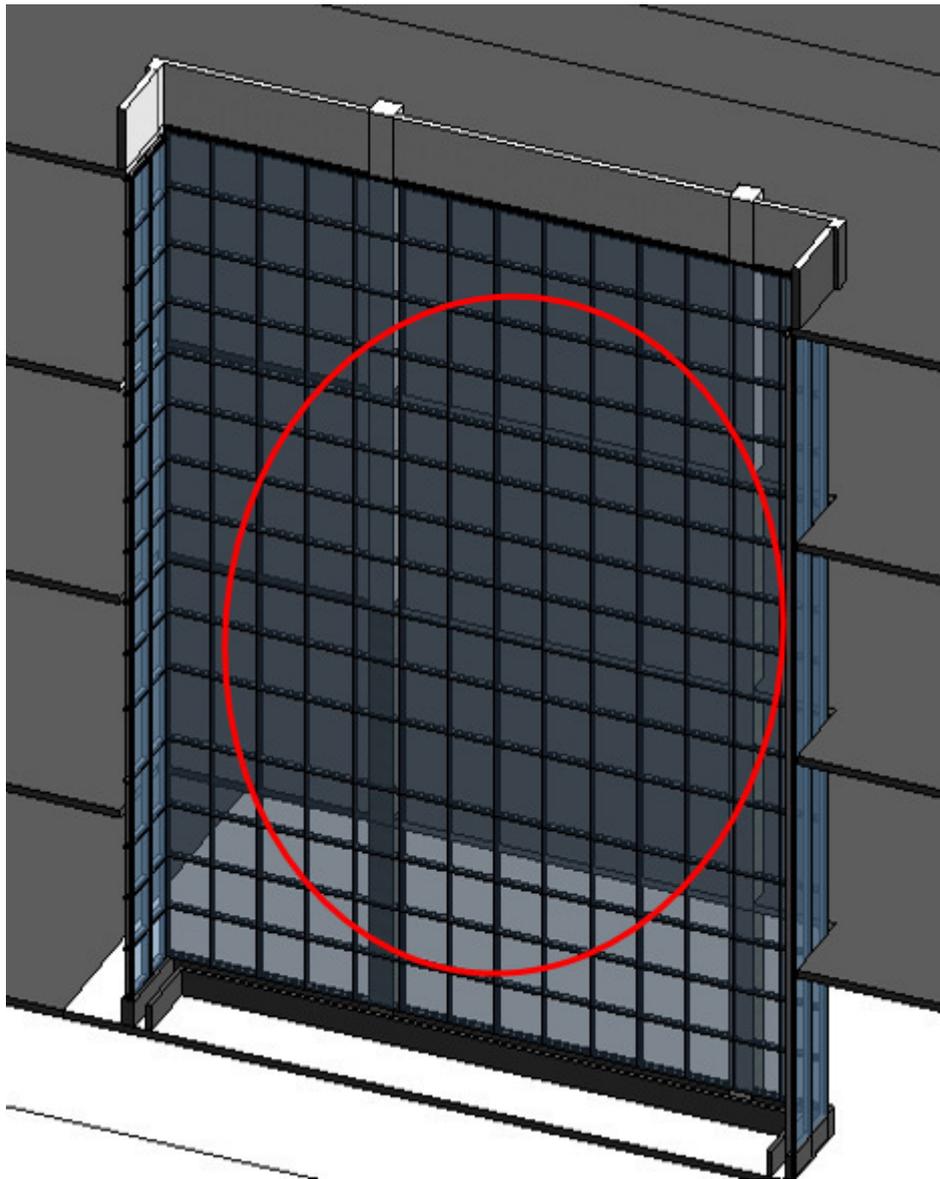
Aumento de ancho en soporte inferior MC-4
